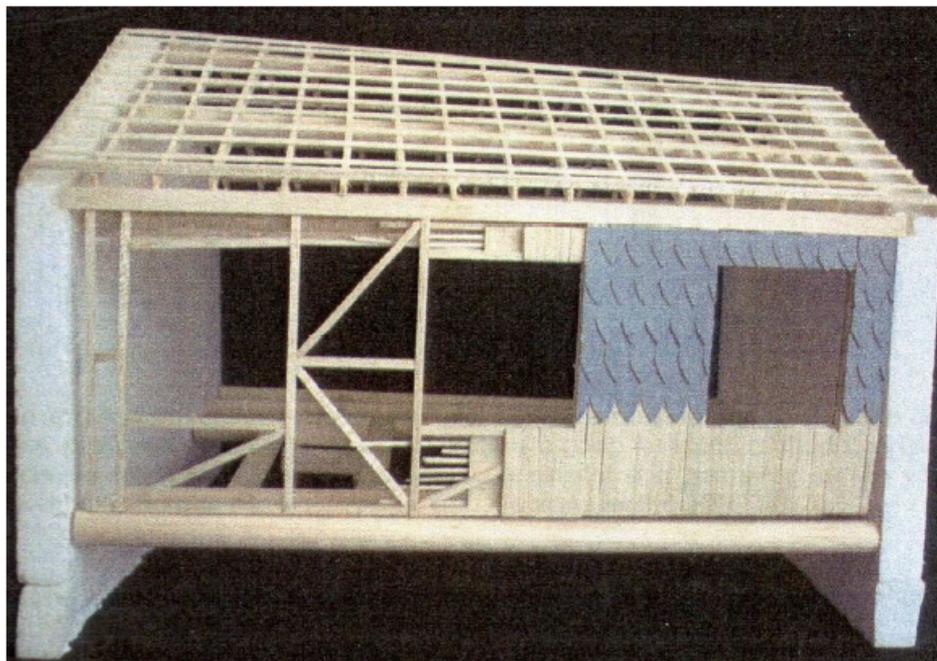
Maquete do sistema construtivo utilizado em paredes de meação (Teixeira, 2004, p.116)
